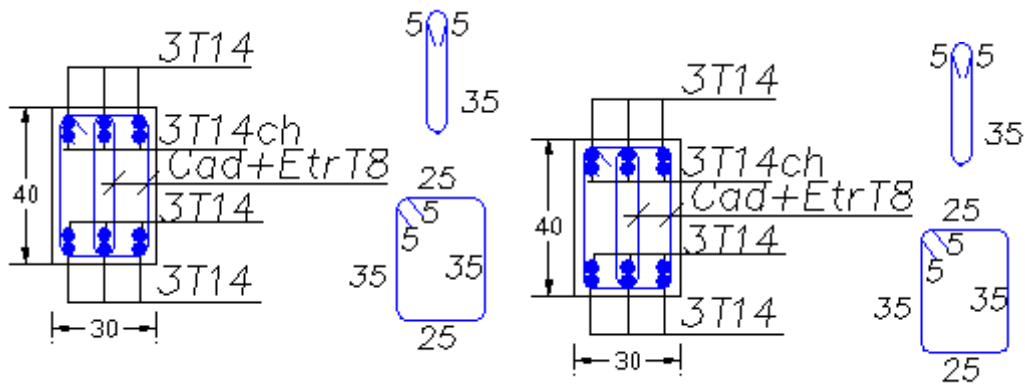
Sections et ferrailage des poutres principales et secondaires.
